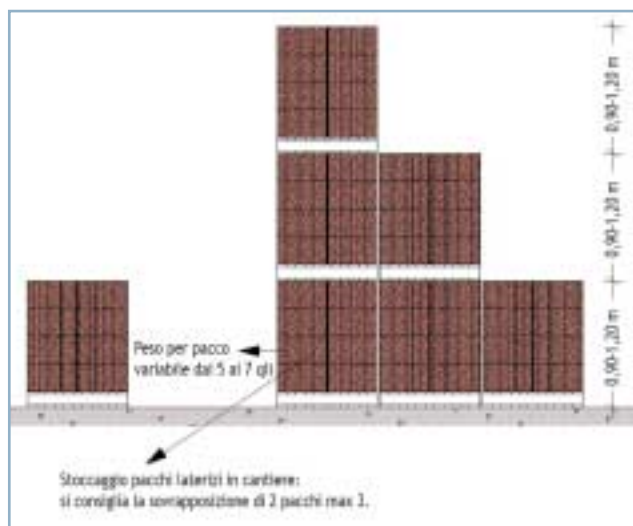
Corretta sovrapposizione dei pacchi di laterizio.
